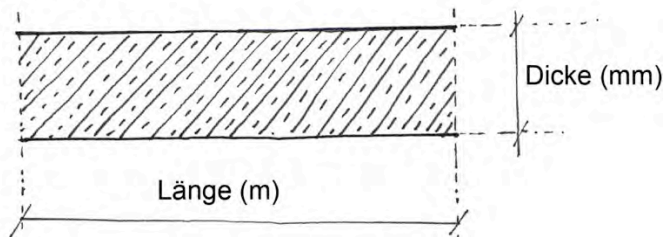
Bestand Wand, Bestand Stahlbeton
